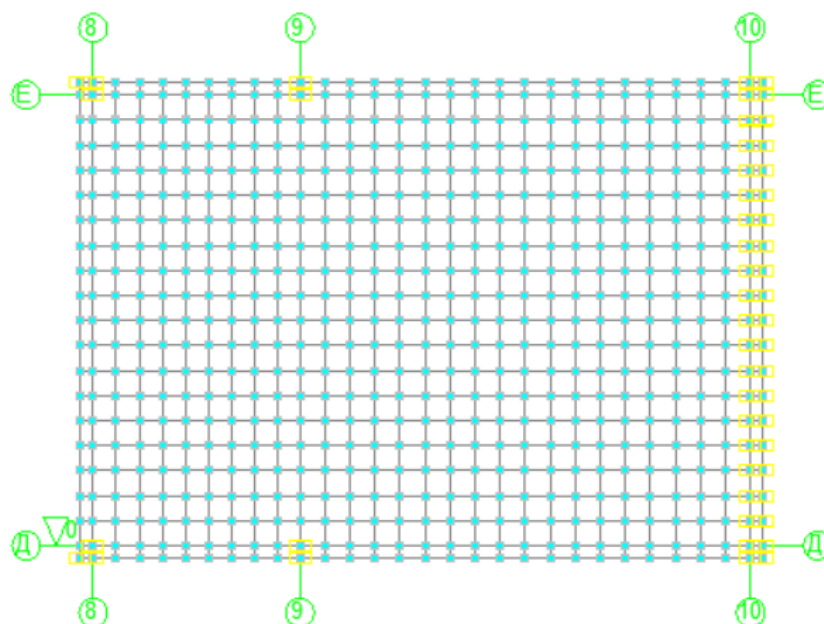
Конечно элементная модель монолитной плиты перекрытия
